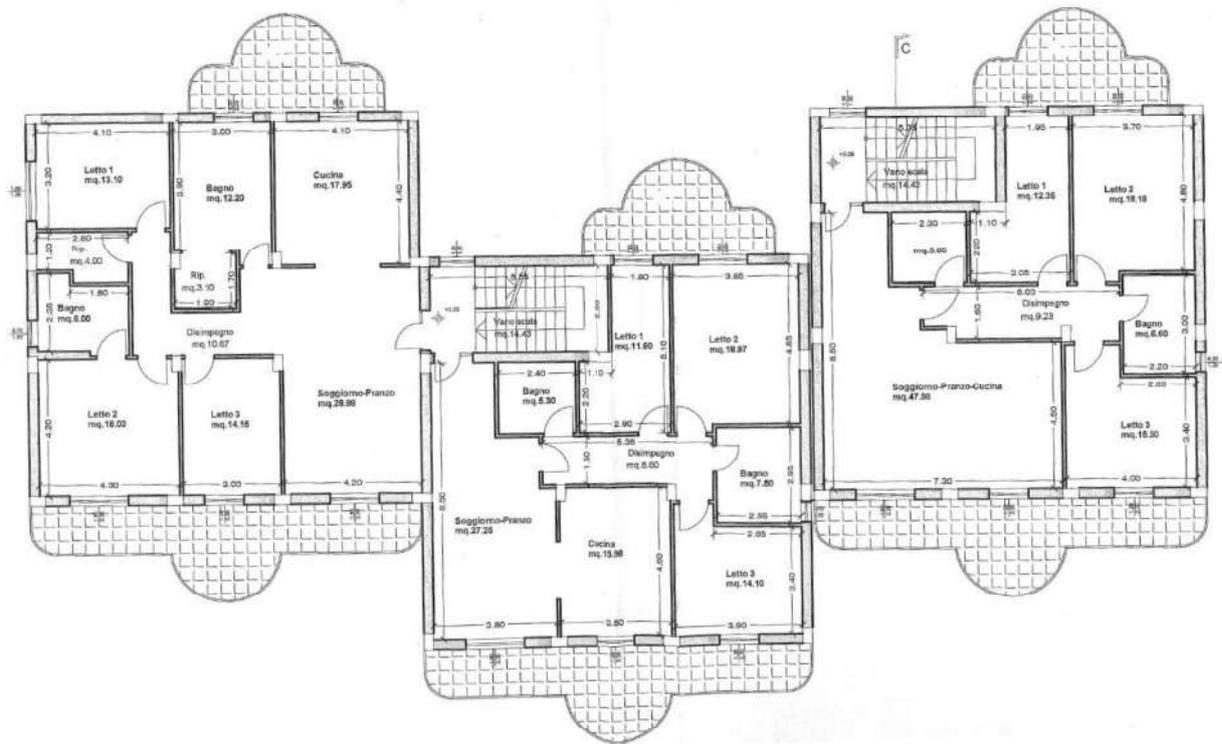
Pianta piano 1° (F. ■ p.lla ■ sub. ■ allegata alla S.C.I.A. - Prot. n. ■ del 10.2.2011 (appartamento)
